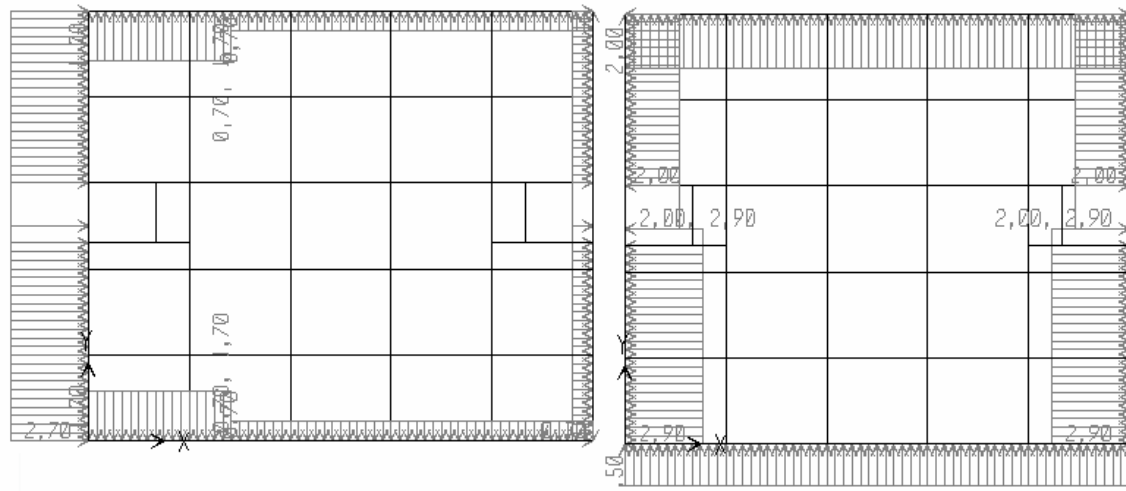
Carregamento de vento do 16º ao 19º pavimento nas direções x e y.
